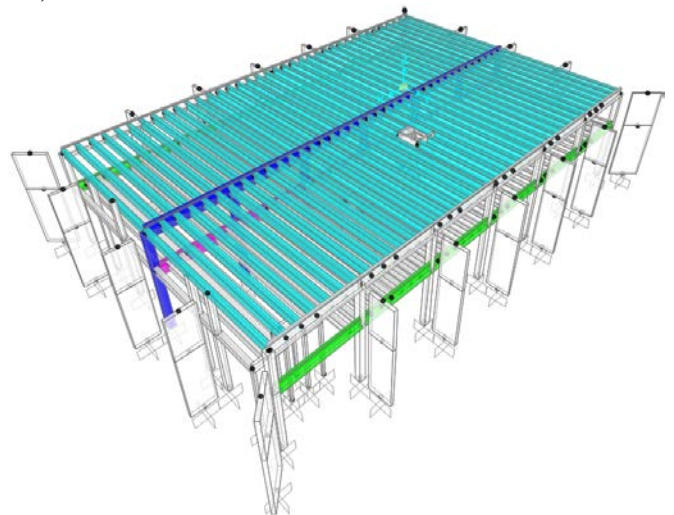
Vista 3D del modello FEM della soluzione di adeguamento sismico progettata.
